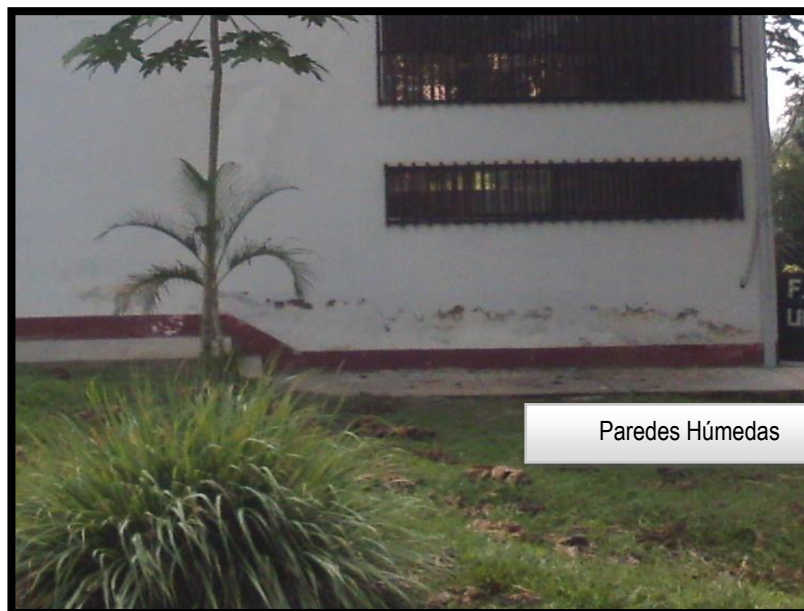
Vista de fisuras por humedad en la mampostería
